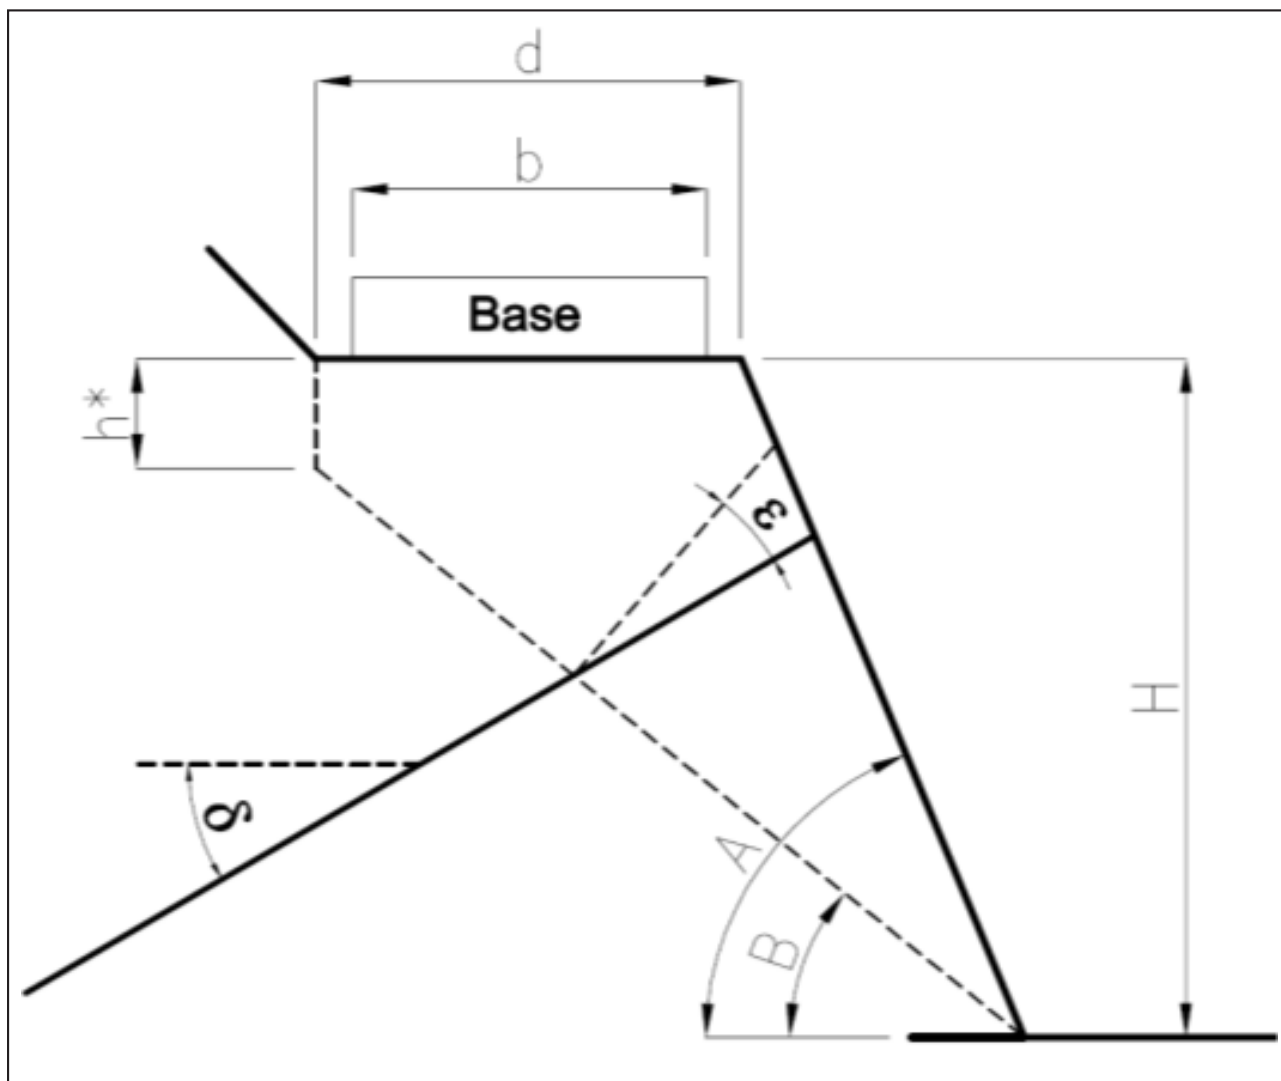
Esquema de cimentación superficial sobre modelo de rotura sobre plano de discontinuidad.
